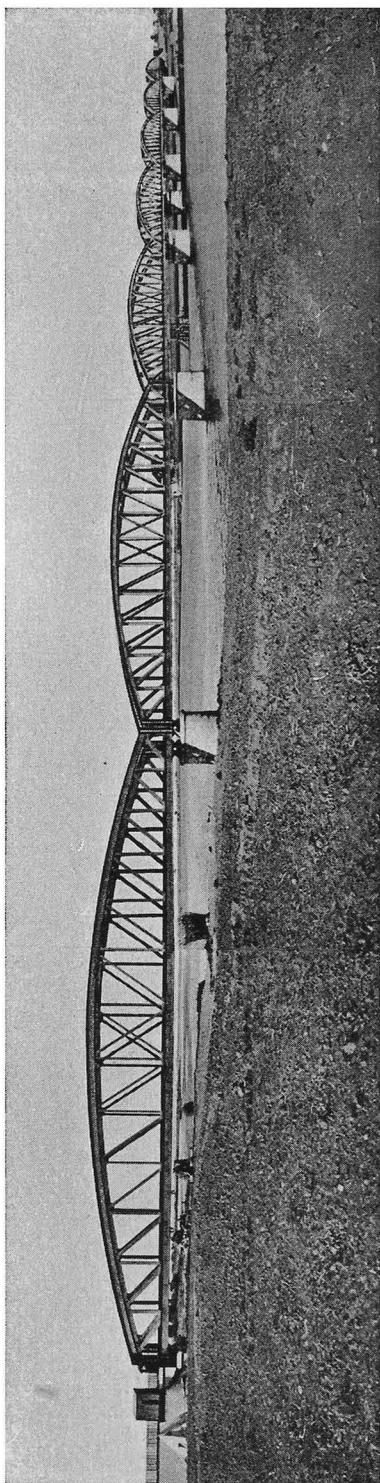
Le pont du Barrage sur le Nil (construit par l'Impresa Industriale).
